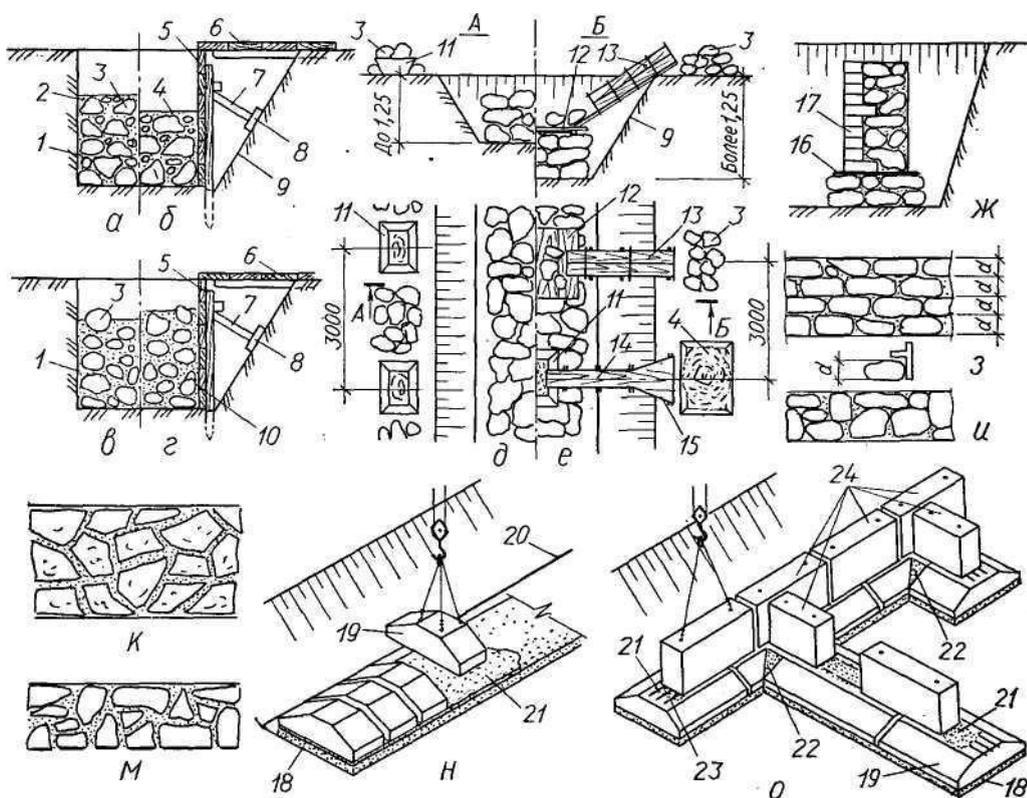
Возведение конструкций подземной части зданий из бутового камня и крупных бетонных
